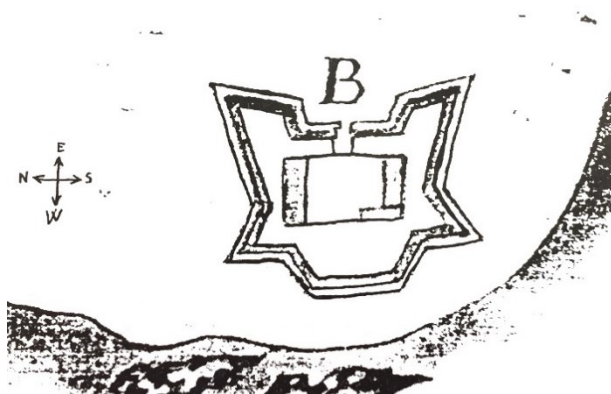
Desenho do Forte de São João Batista realizado por Gonçalo Luís da Silva Brandão
